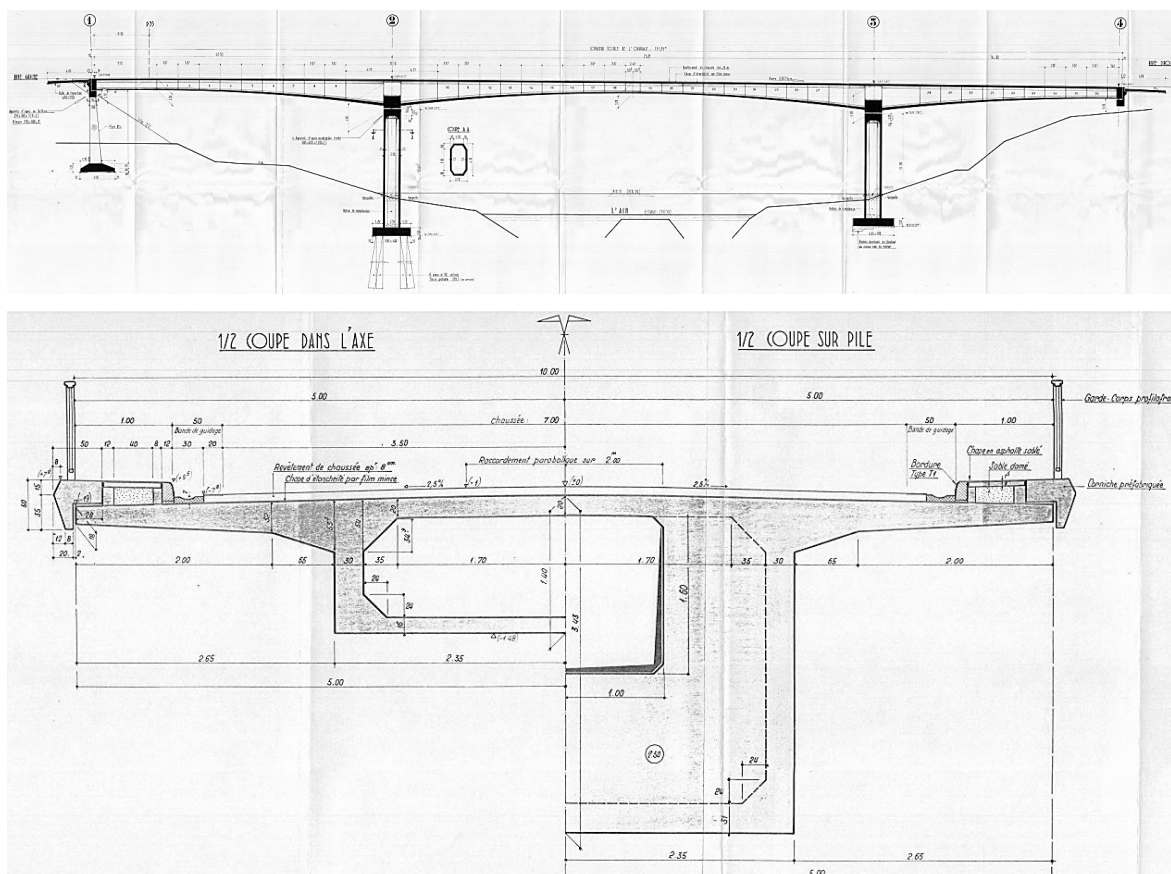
Coupe longitudinale et coupe transversale dans l'ouvrage (documents d'archive)
